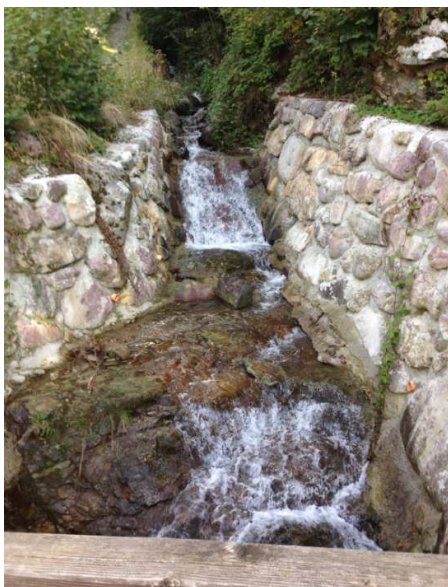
Valle Caravino a monte dell'attraversamento stradale
